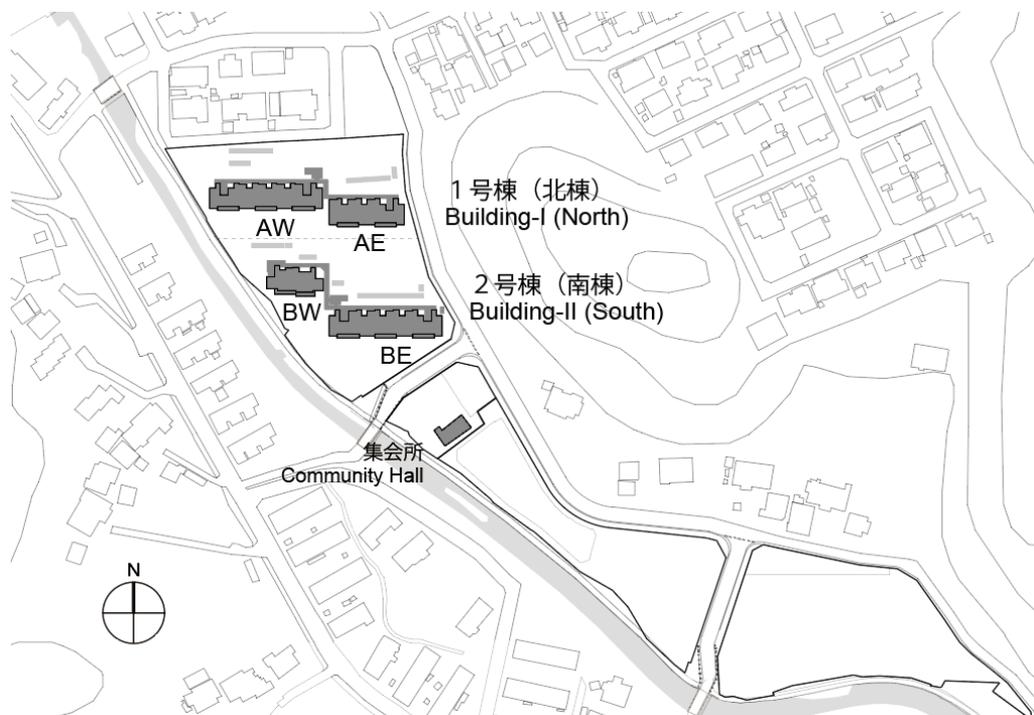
いわき CLT 復興公営住宅の配置図 IWAKI CLT public housing for revitalization site plan
